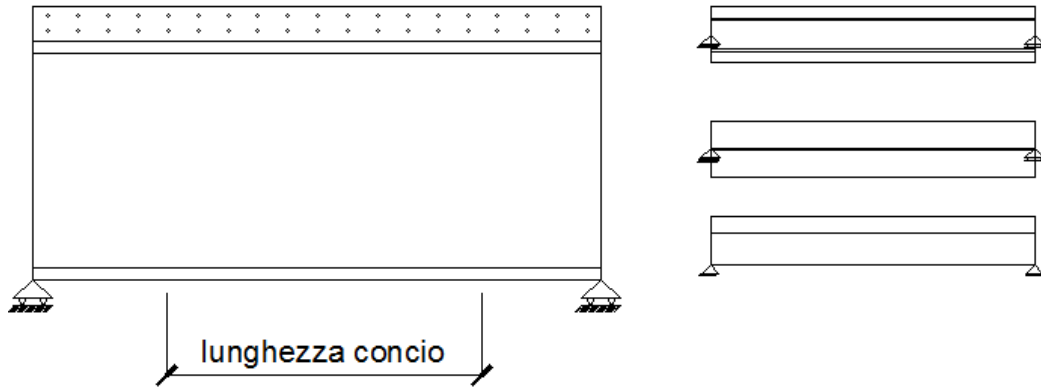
Striscia larga 1 m di sezione longitudinale di impalcato e schema statico di calcolo adottato per la soletta in direzione trasversale.
